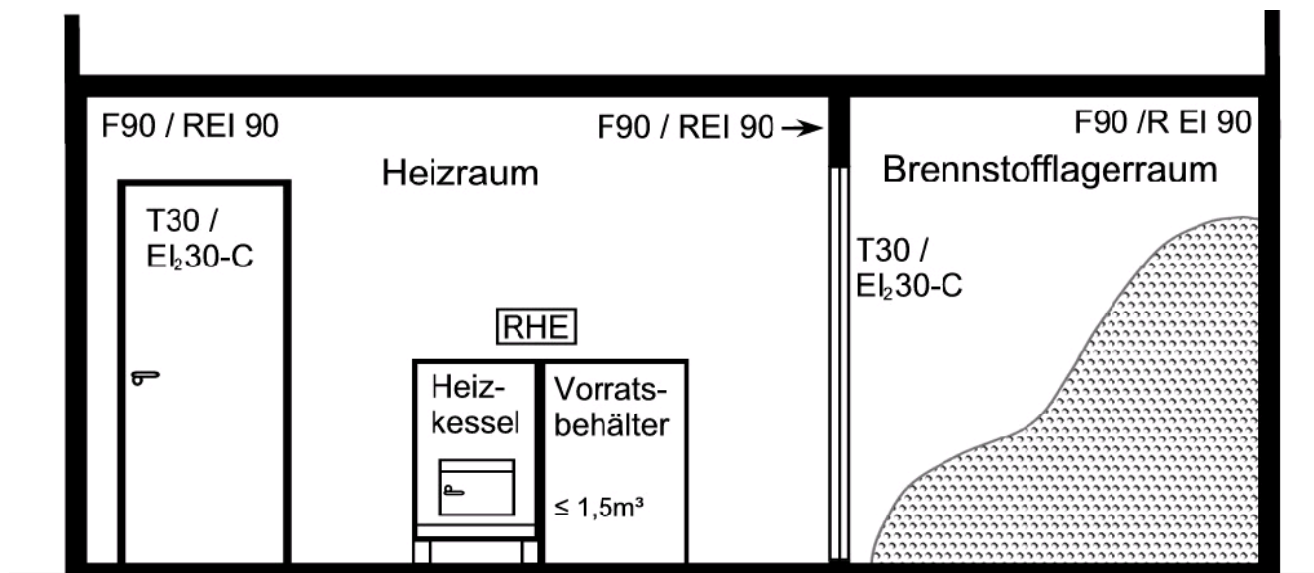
Kompaktanlage im Heizraum (5.1.3) mit anschließendem Brennstofflager (5.1.3), Heizleistung ≤ 150 kW, Brennstoff gemäß Punkt 3.1 (Hackgut)
